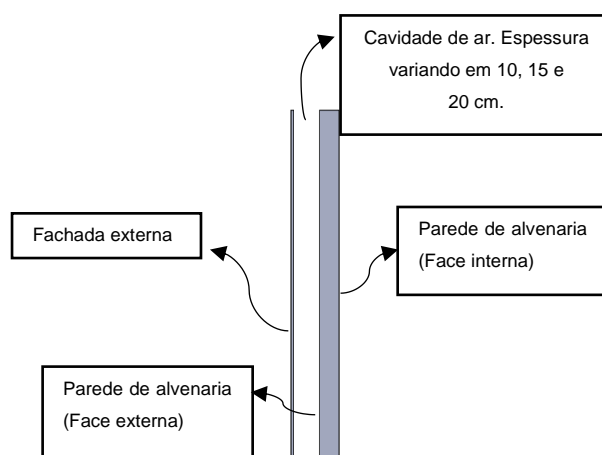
Vista esquemática (lateral) da construção da fachada dupla
